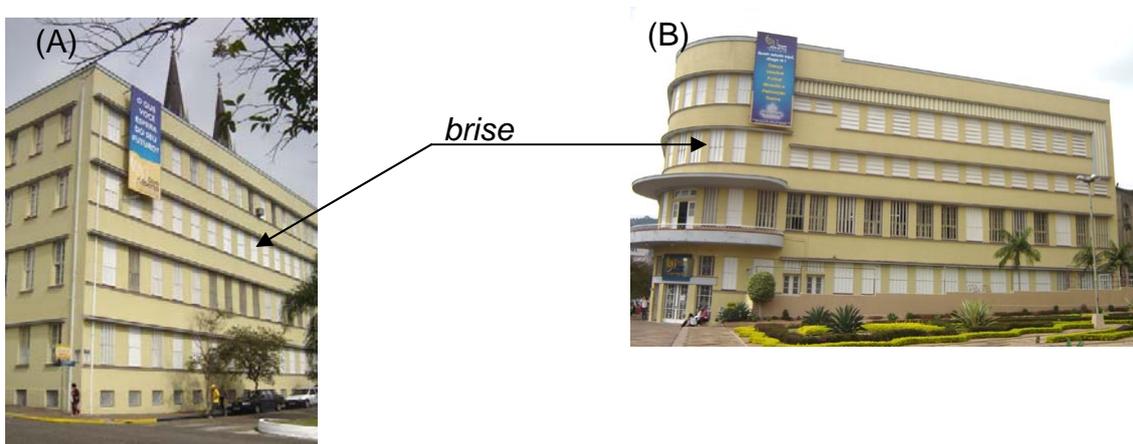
Vista externa – (A) fachada Norte (B) fachada Oeste
